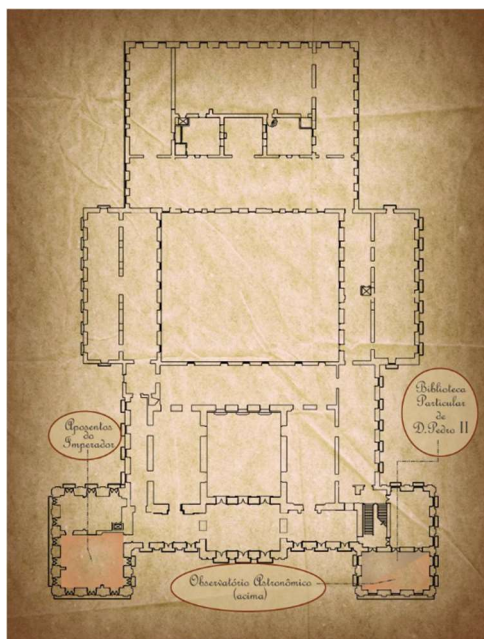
Planta do segundo pavimento onde era concentrado a maior parte das exposições do Museu.
